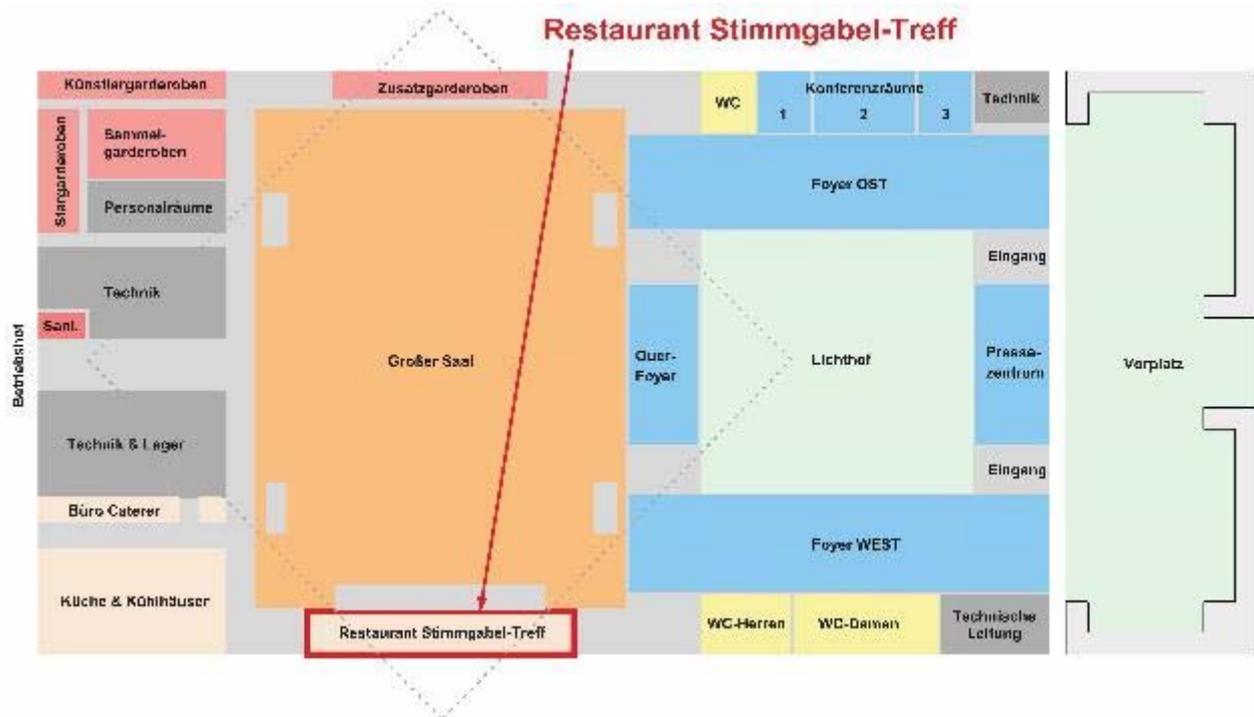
Hallengrundrissplan mit Restaurant „Stimmgabel Treff“ und Zusatzgarderoben
